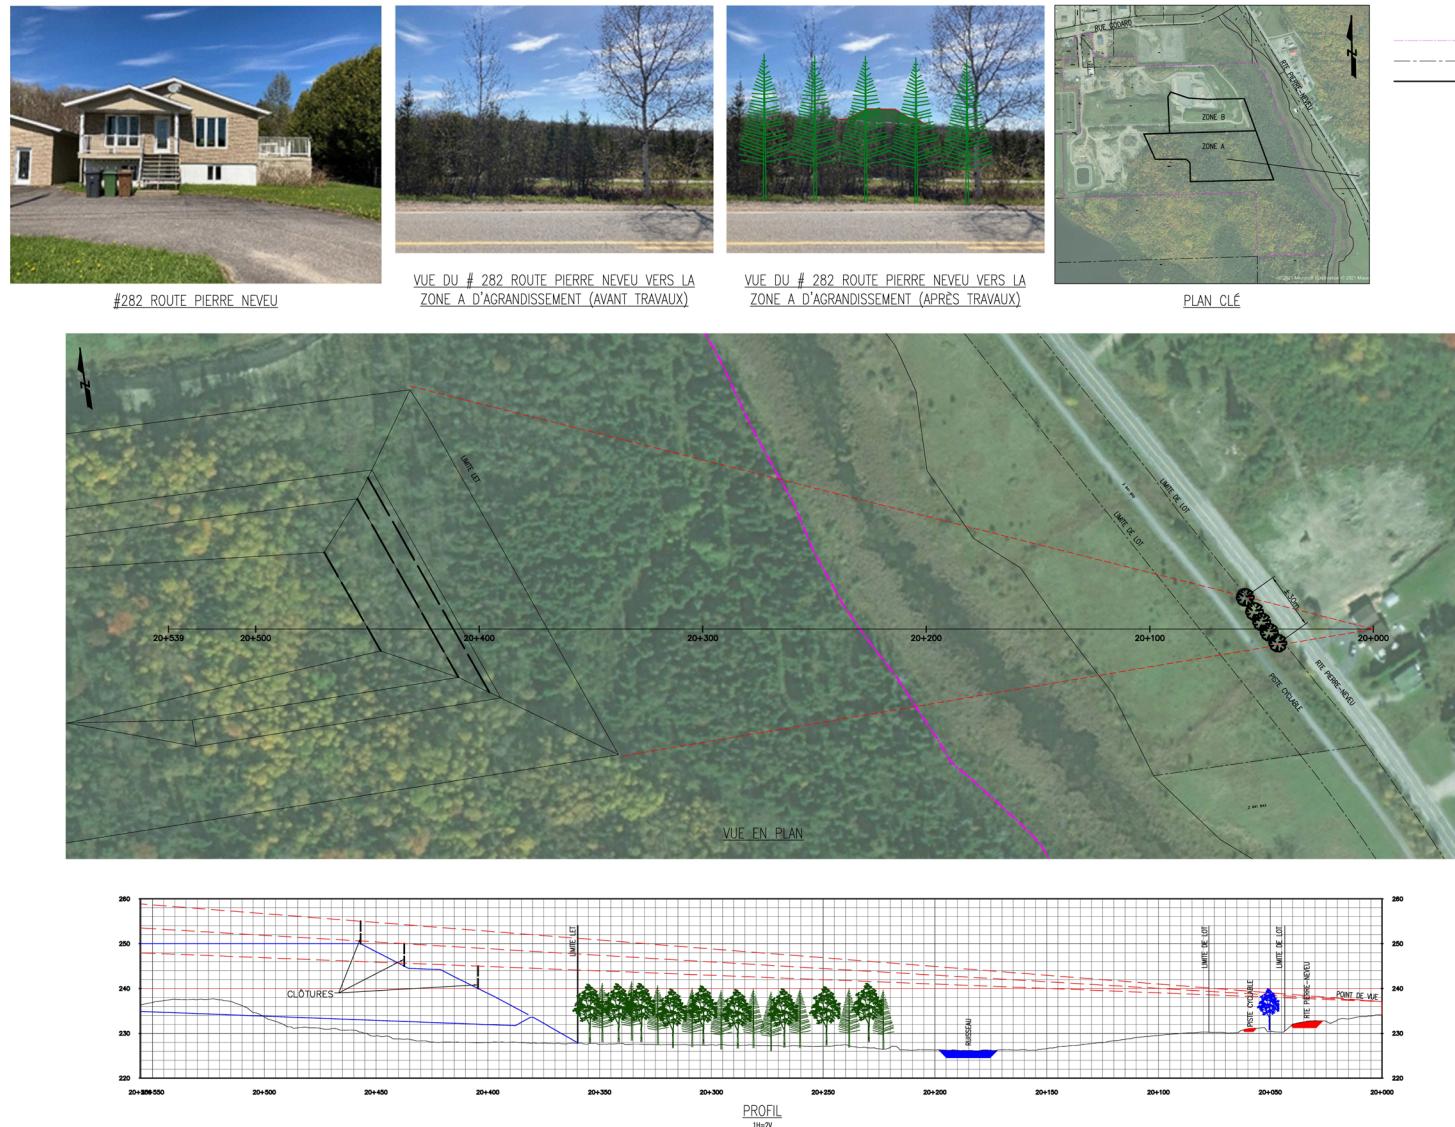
Mesures d'atténuation proposées Coupe et Plan PV-1
